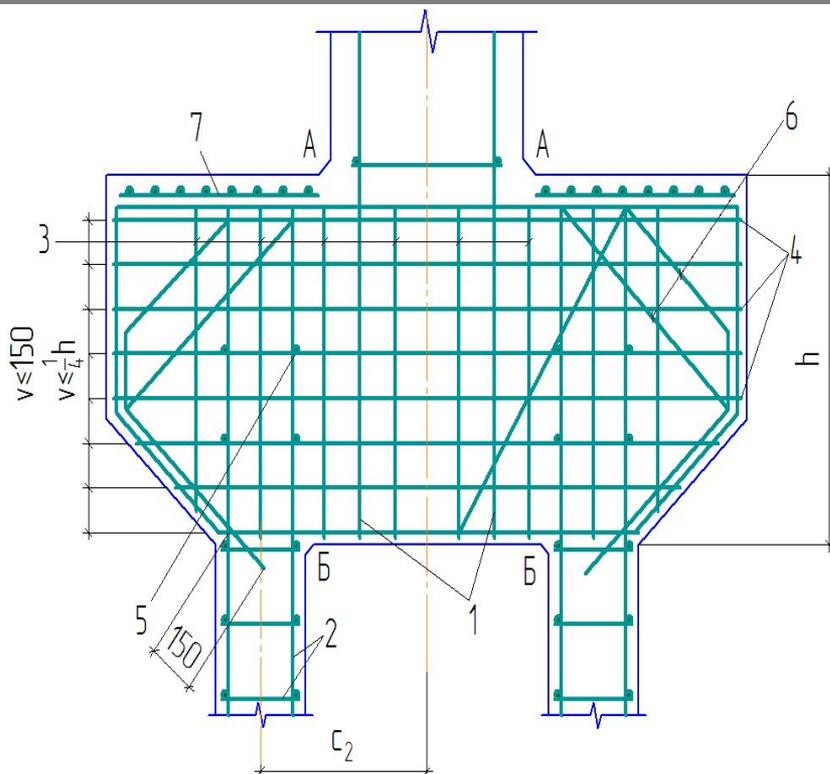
Конструирование сопряжения верхней распорки с ветвью крановой двухветвевой колонны среднего ряда
